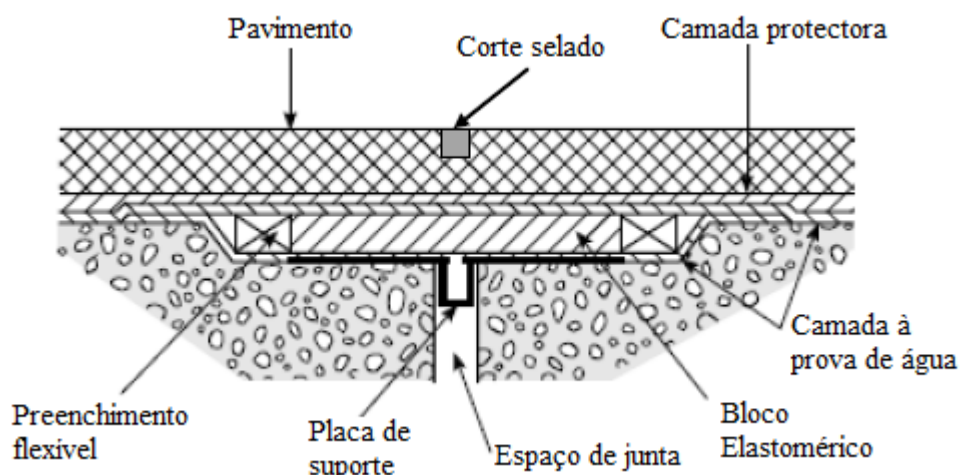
Junta de dilatação enterrada (Adaptado) [17]
